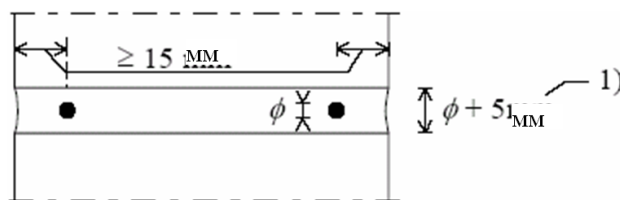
Покриття сталі, що армус на горизонтальних швах
